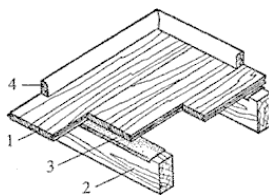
Цокольное перекрытие по балкам: 1 – доска пола; 2 – балка; 3 – рубероид; 4 – плинтус.
